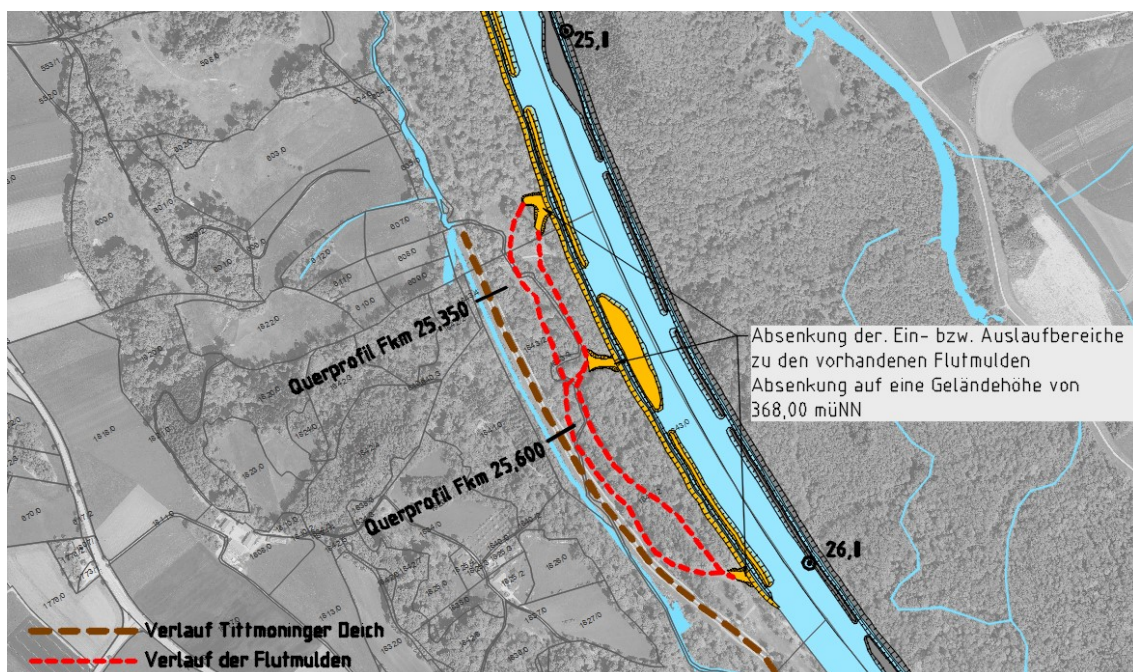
Lageplan Fkm 26,2 bis 25,0
